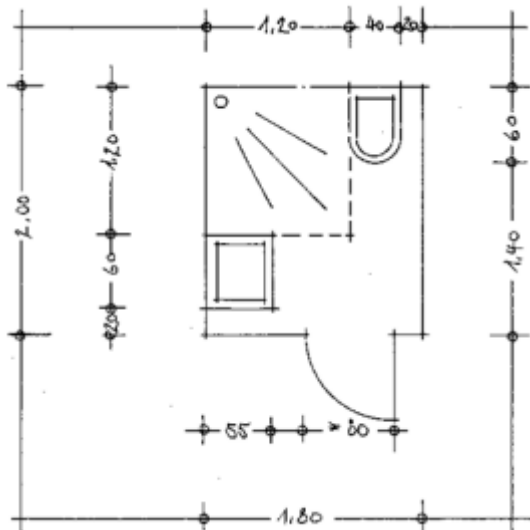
Bewegungsfläche vor Einrichtungen im Sanitärraum bzw. im schwellenlos begehbaren Duschbereich
